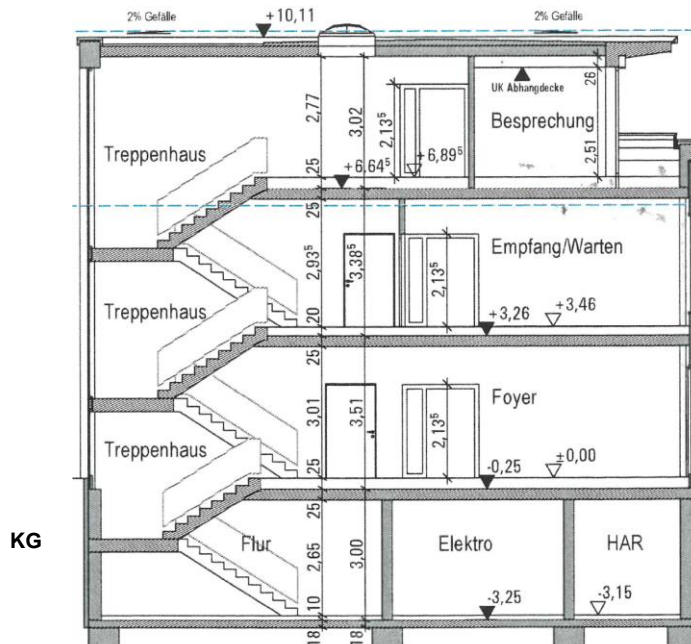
Beispiel 3-geschossiges Bürogebäude
